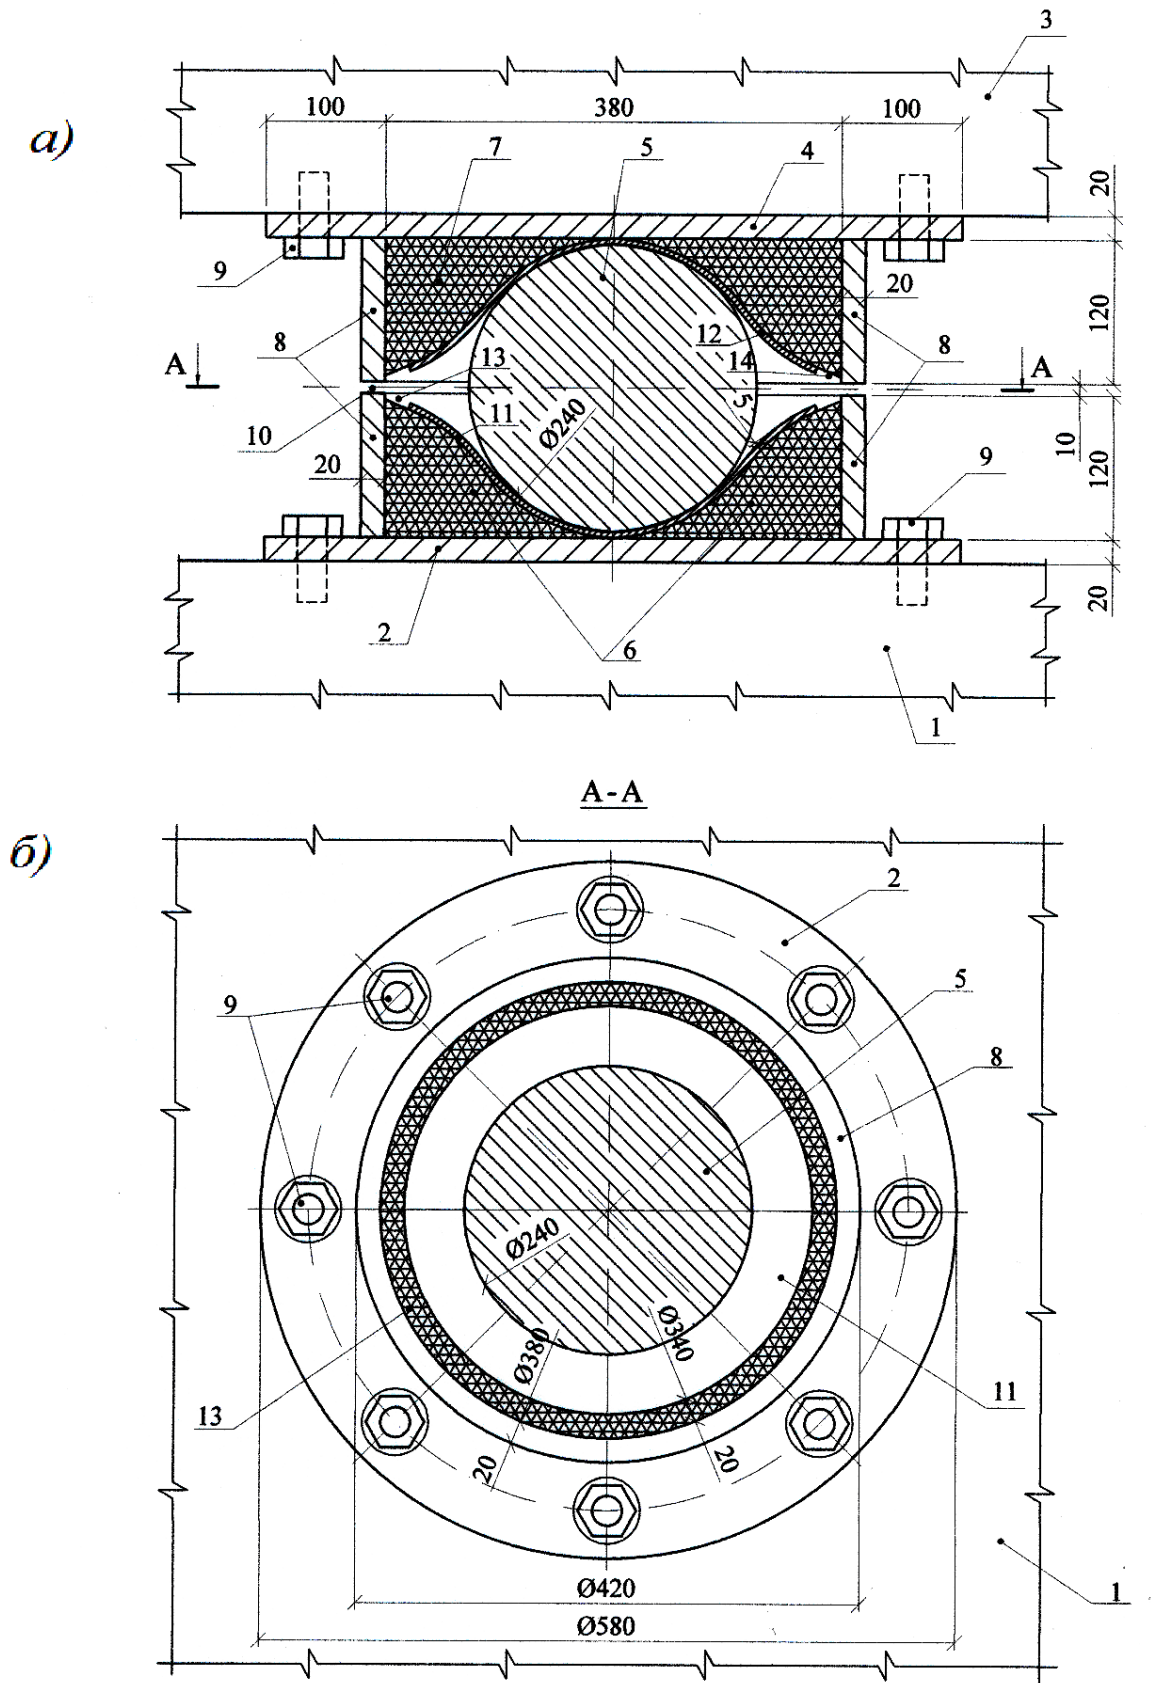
Сейсмоизоляционный фундамент с элементами качения и резинометаллическим упруго-демпферным ограничителем: а – общий вид, поперечный разрез; б – вид сверху вниз на нижнюю опорную часть, сечение А-А
